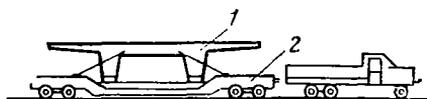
Схема расположения плитно-ребристого блока 1 пролетного строения на специальном авто-трейлере 2
